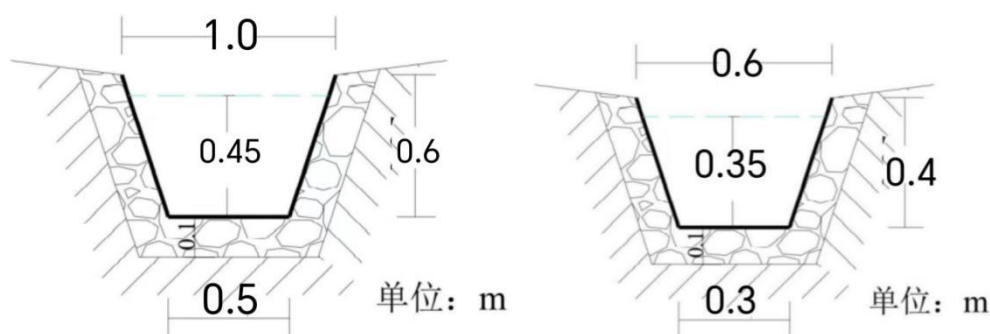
P1、P2 截水沟设计断面图（单位：m）
